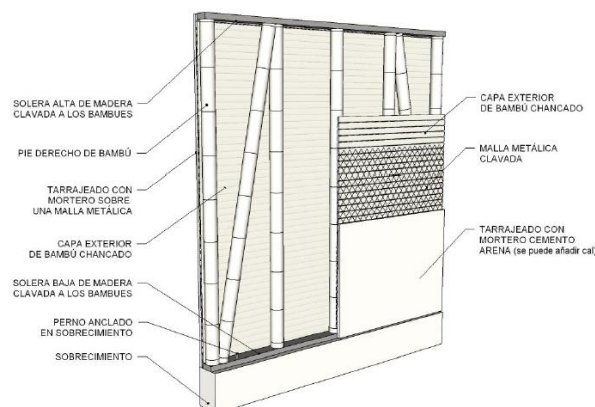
Parede com soleira de madeira - (Ministerio de Vivienda, C.y.S.d.P., 2012)
